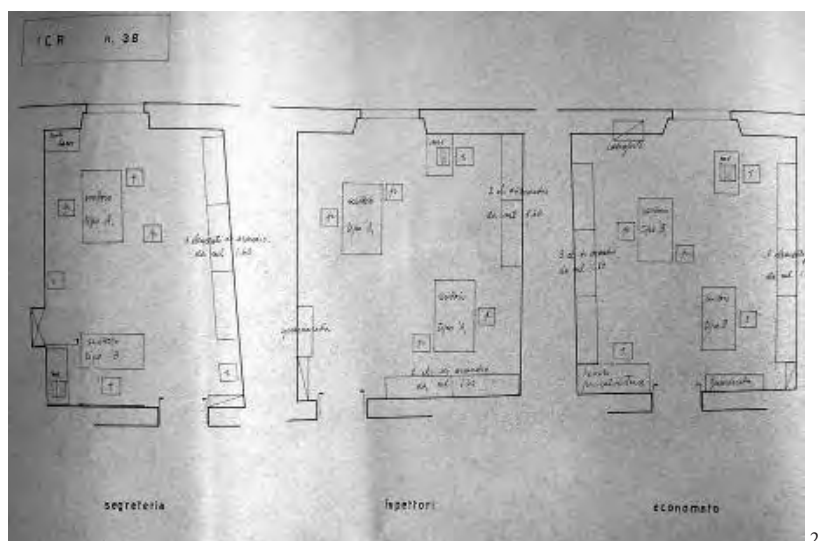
Silvio Radiconcini, Progetto di allestimento del 3° piano dell'Istituto Centrale del Restauro, tavola n. 38 (particolare) (Biblioteca ICR di Roma).
